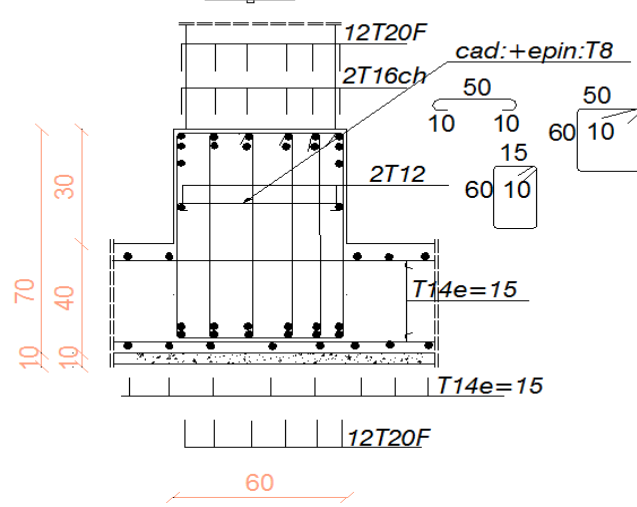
Ferrailage des nervures suivant le sens y-y pour les deux structures.
